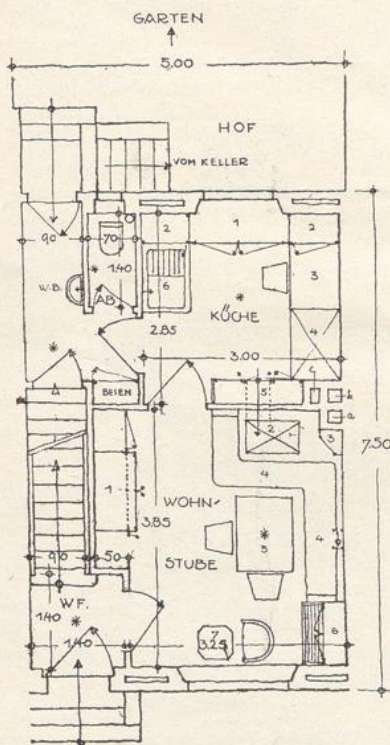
Grundriß des Erdgeschosses. (1:100)
